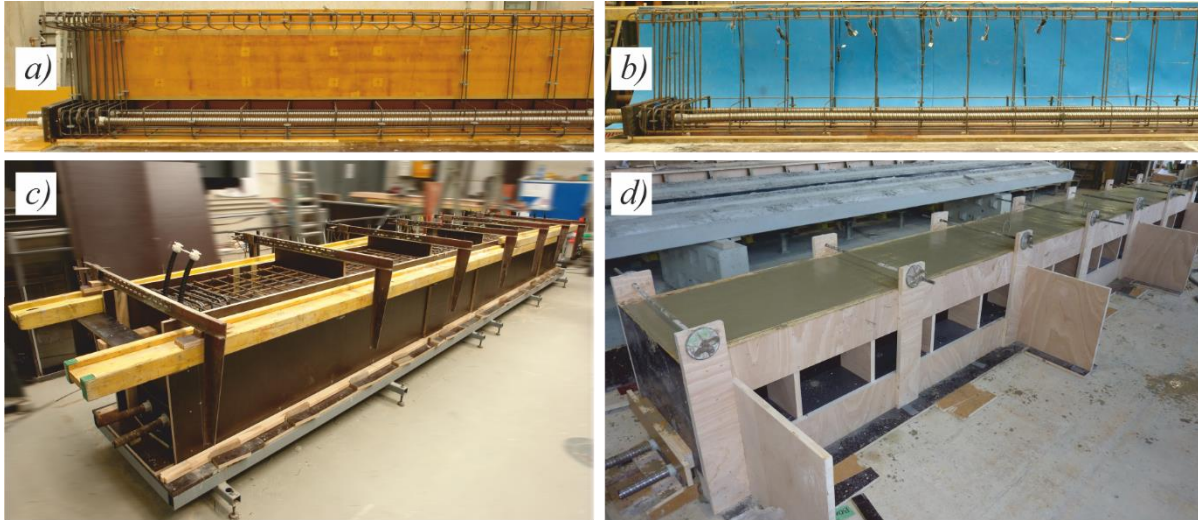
a) Bewehrungskorb I-Träger ohne Querkraftbewehrung; b) Bewehrungskorb I-Träger mit Querkraftbewehrung; c) Schalboden in Halle G des IMB; d) Rütteltisch in Fertigteilwerk
